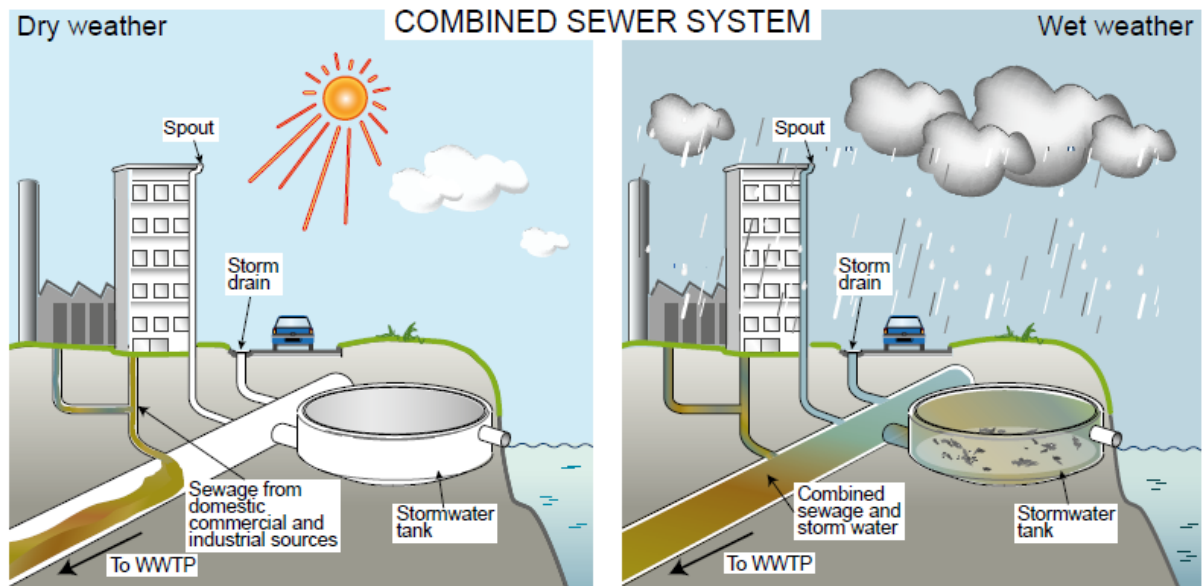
Esquema de funcionamiento de tanque de tormentas en paralelo (Design of StormWater Tanks. Grundfos)
